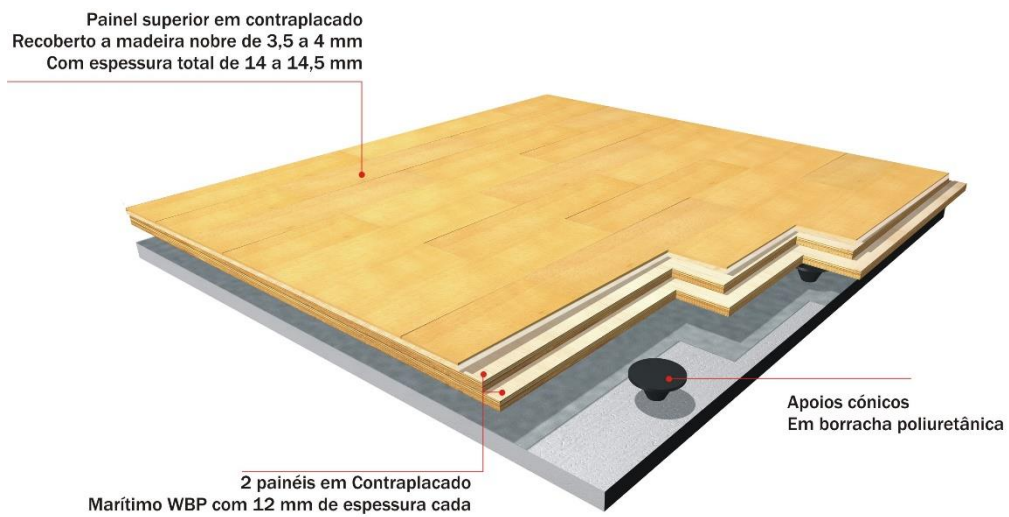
Figura I – Pavimento Desportivo em madeira flutuante e flexível em camadas
